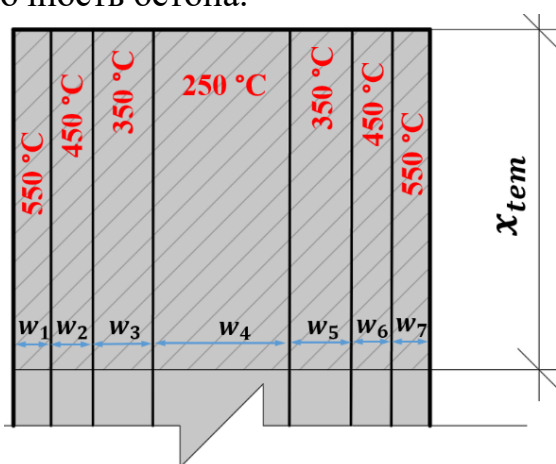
Фрагментированное сечение сжатой зоны железобетонной балки, обогреваемой с трех сторон при пожаре:  $w_1 \dots w_7$  — ширина рассматриваемых зон сжатой зоны железобетонной, м; балки;  $x_{tem}$  — высота сжатой зоны, м
